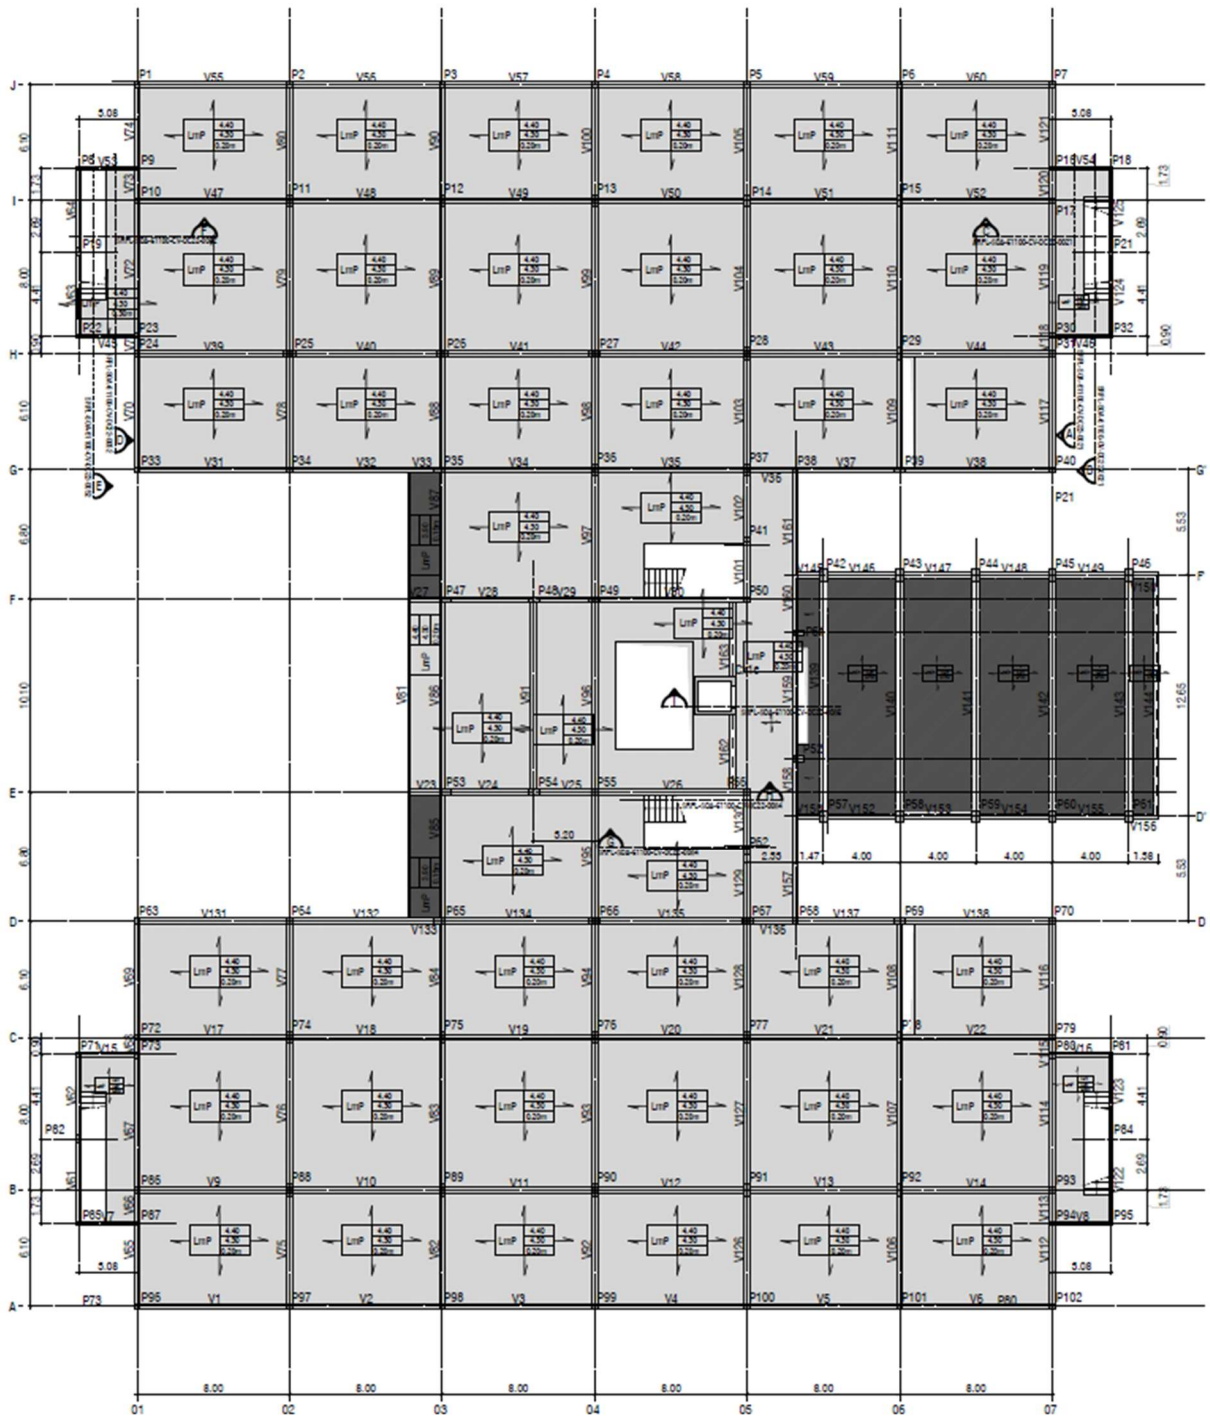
Planta Estrutural do Piso 2 do Projeto Executivo
